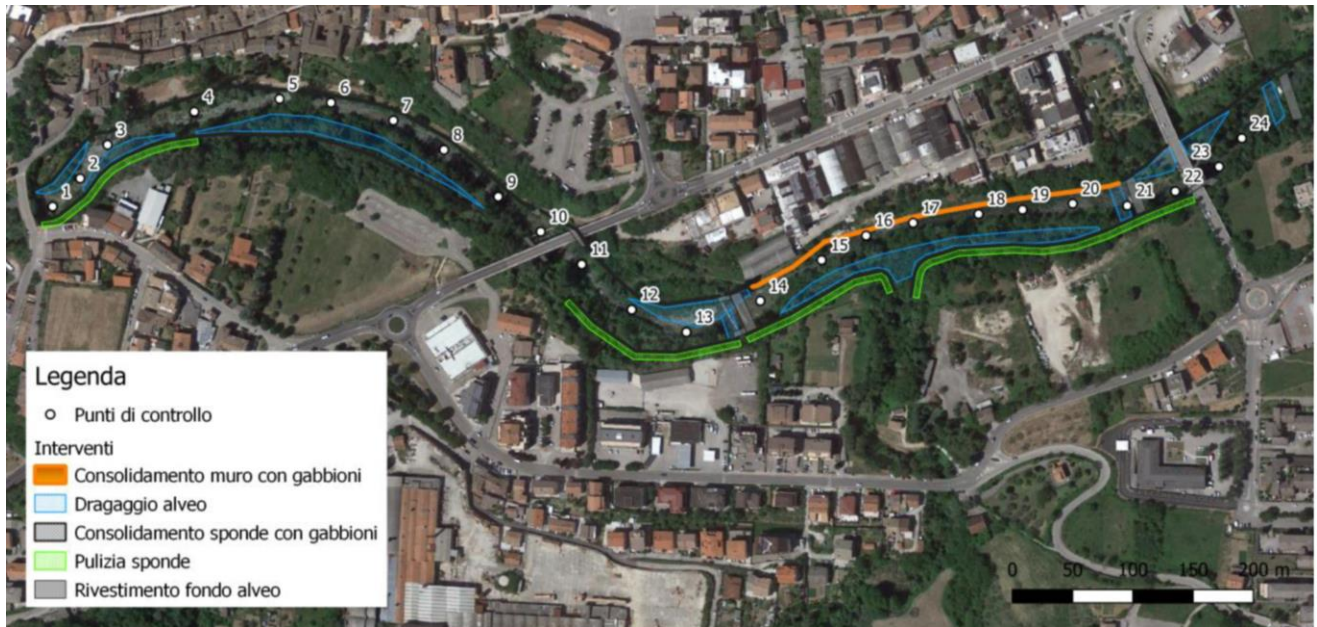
Rappresentazione planimetrica della configurazione SP tramite individuazione degli interventi di progetto
